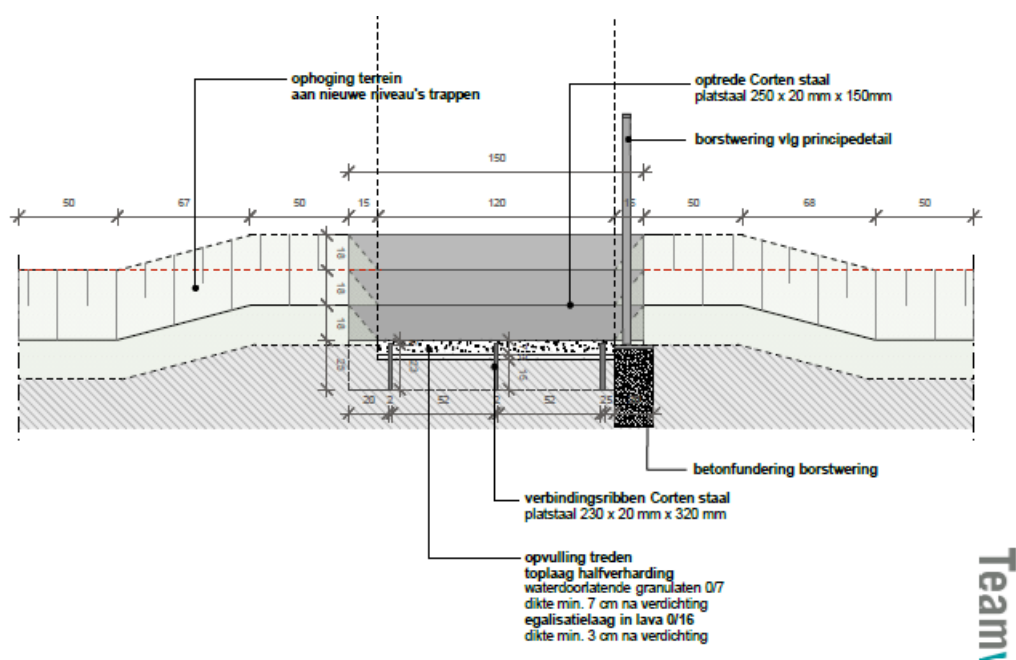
Doorsnede van de top van de motteheuvel met de betonplaat fundering en het uitkijkpunt (bron: Opdrachtgever).
